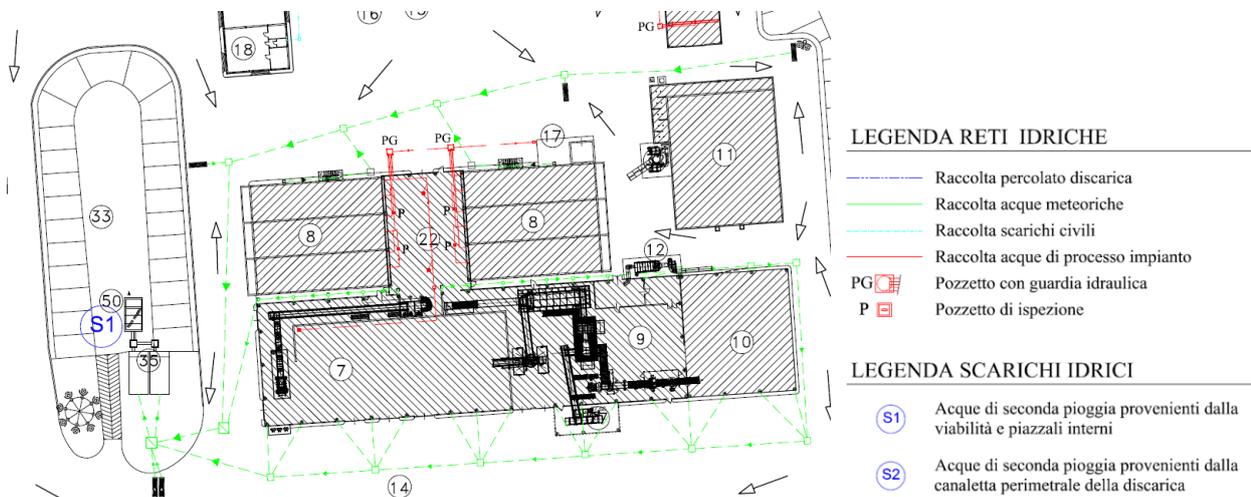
Stralcio da Allegato 6 – Planimetria reti e scarichi – Acque meteoriche
